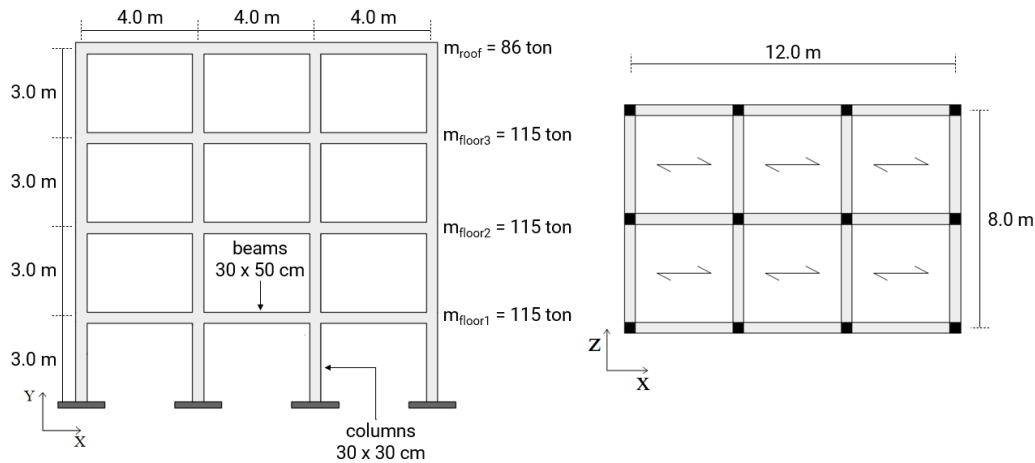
Pianta strutturale e sezione verticale dell'edificio di studio.
